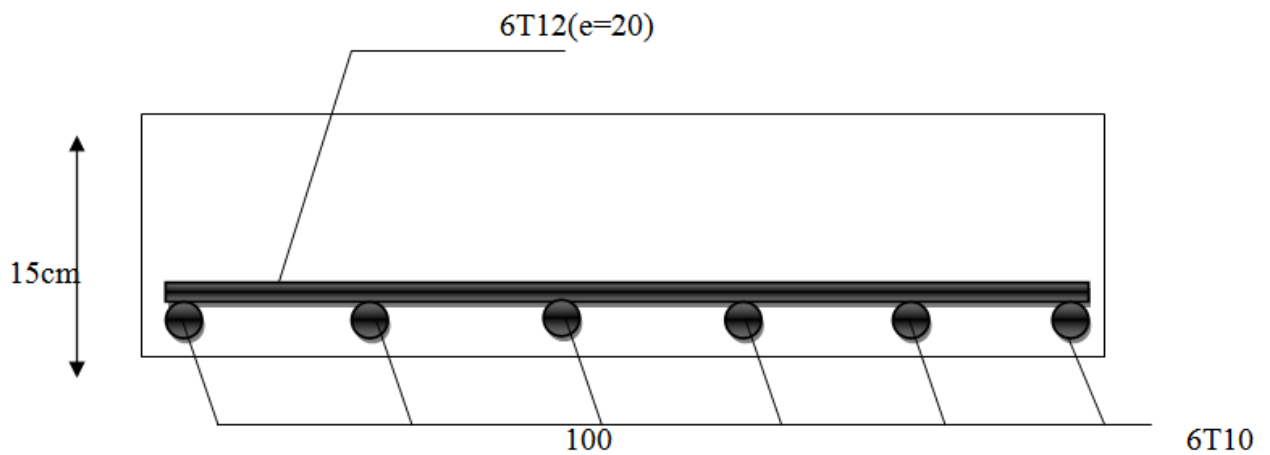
Schéma de ferrailage de l'escalier en travée
